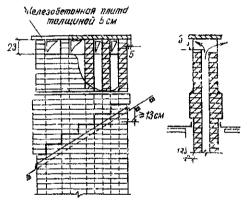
Схема дымовых каналов, перекрытых железобетонной плитой
